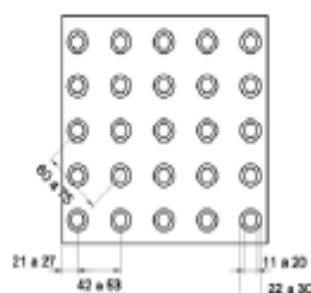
Sinalização tátil de alerta - Modulação do piso
